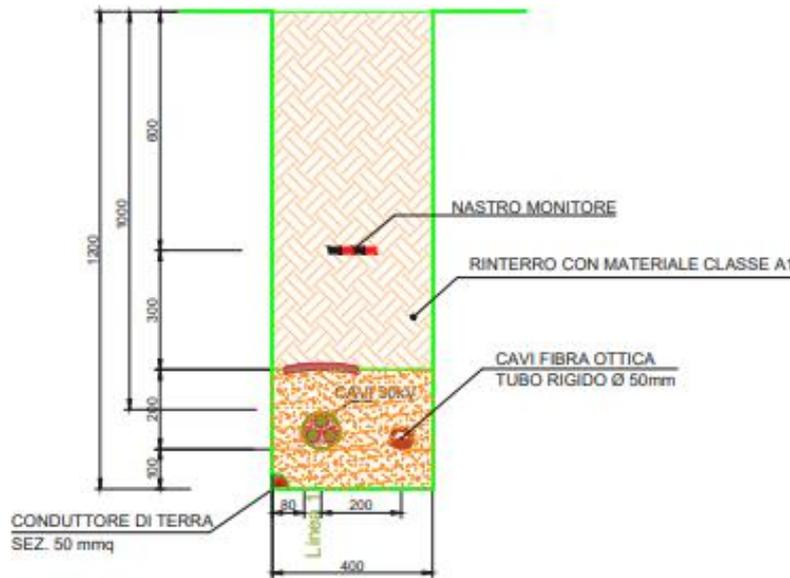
Sezione di scavo Cavo MT + cavo segnale e corda di rame su terreno
